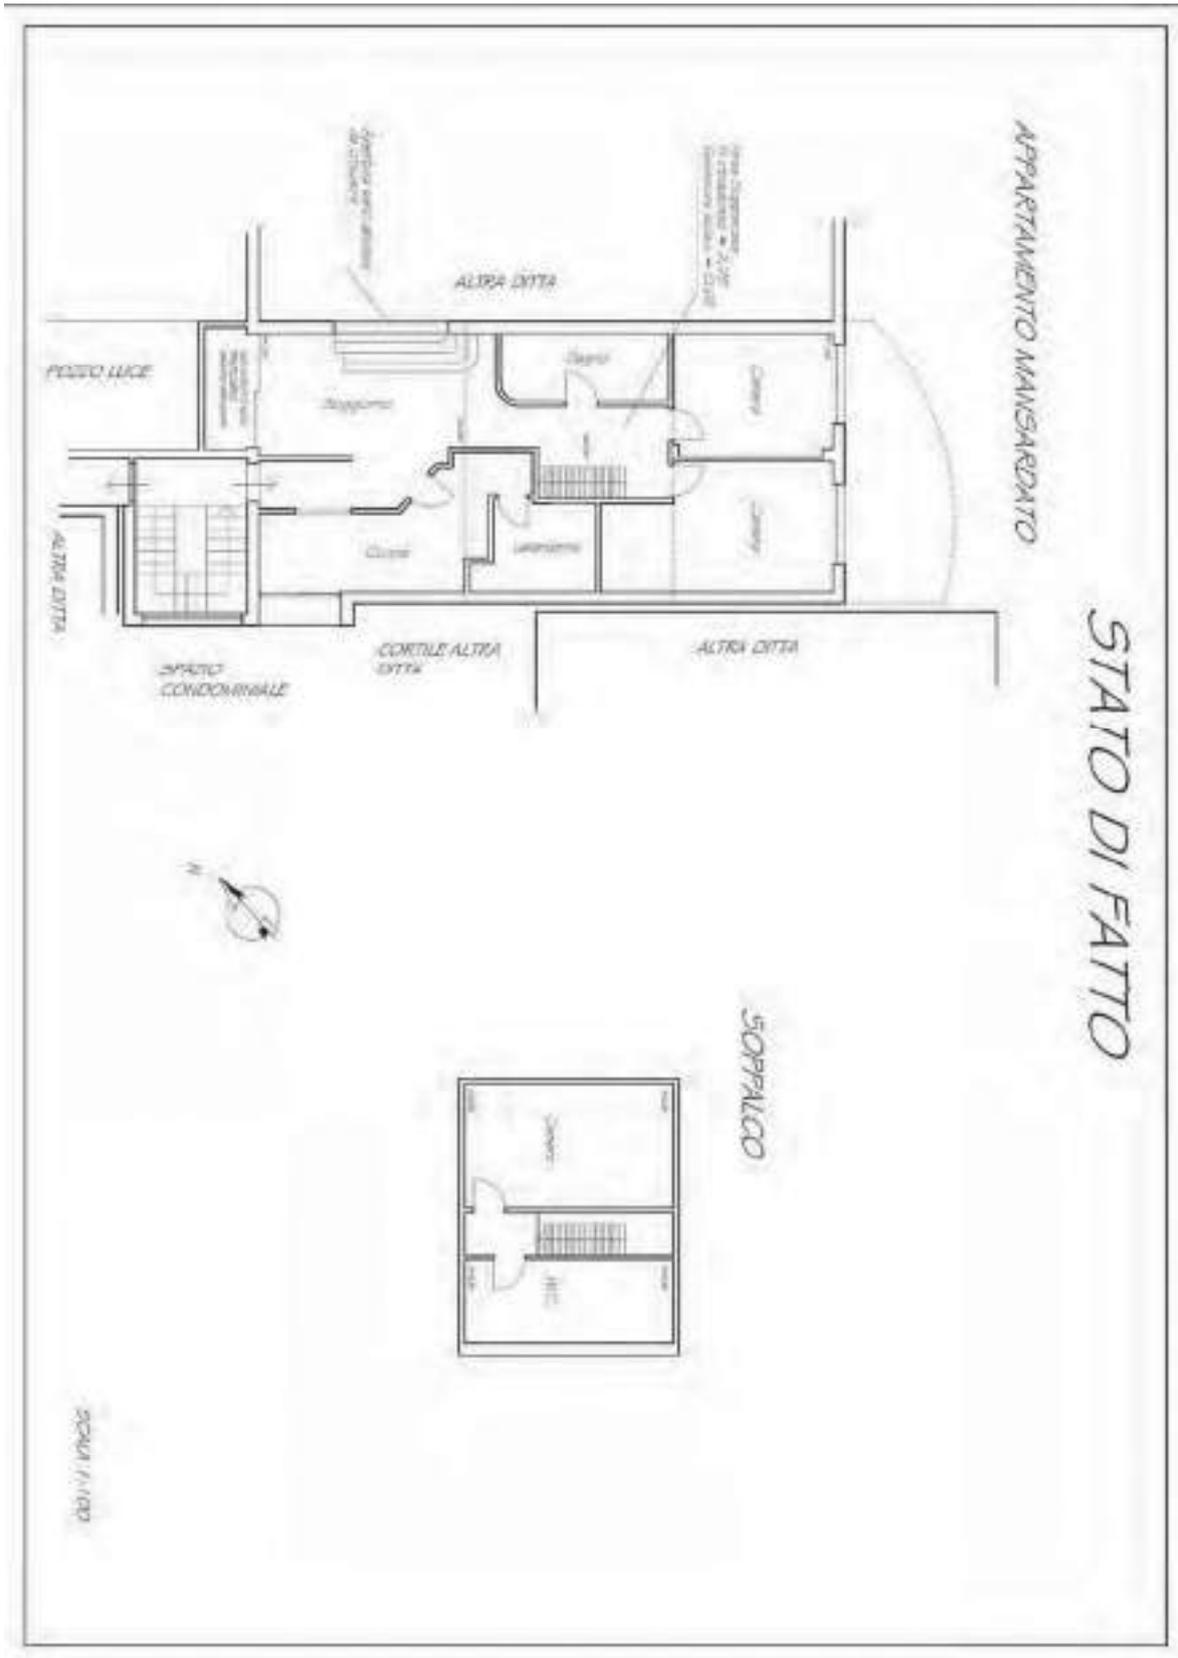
Planimetria Stato di Fatto (allegato fuori scala)
